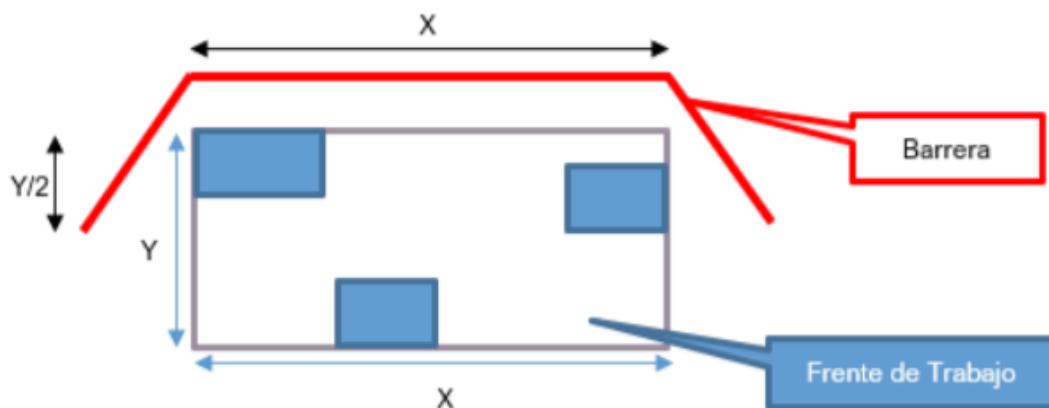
Esquema de barrera acústica modular tipo corchete.
